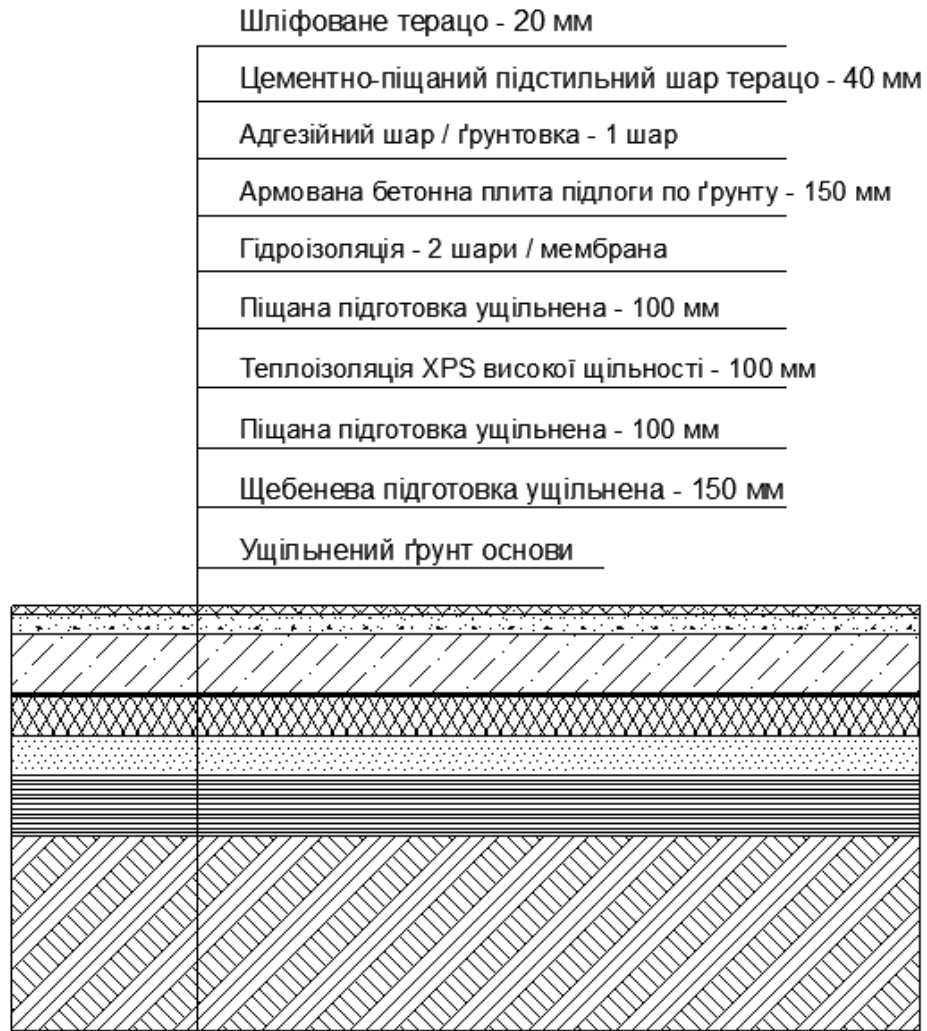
Розрахункова схема підлоги першого поверху по ґрунту
